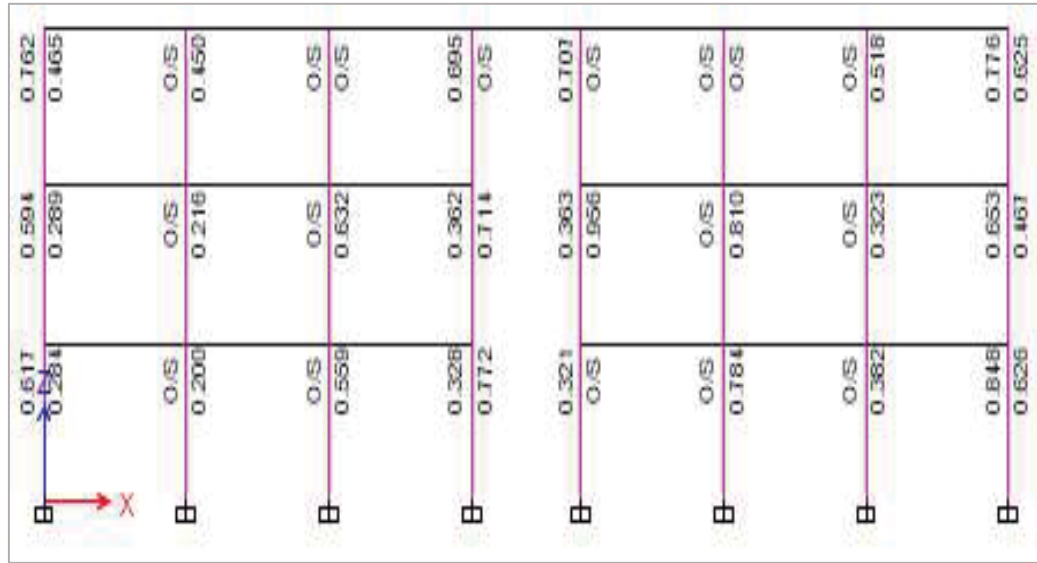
Interacción columna fuerte – viga débil dirección X-X. (Elaboración propia).
